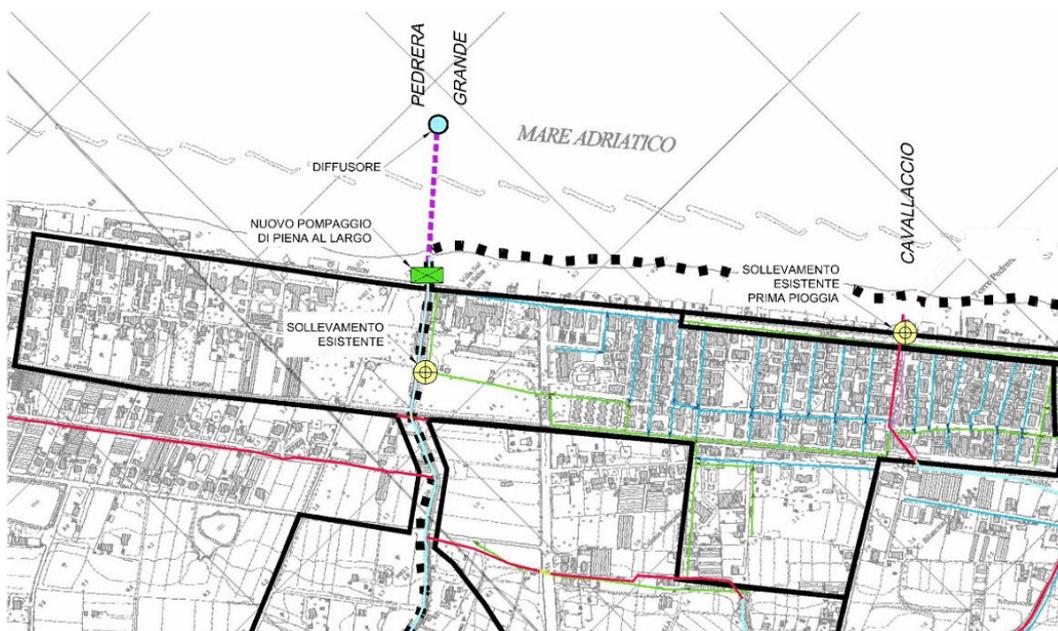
Individuazione planimetrica dell'intervento Pedrera.
